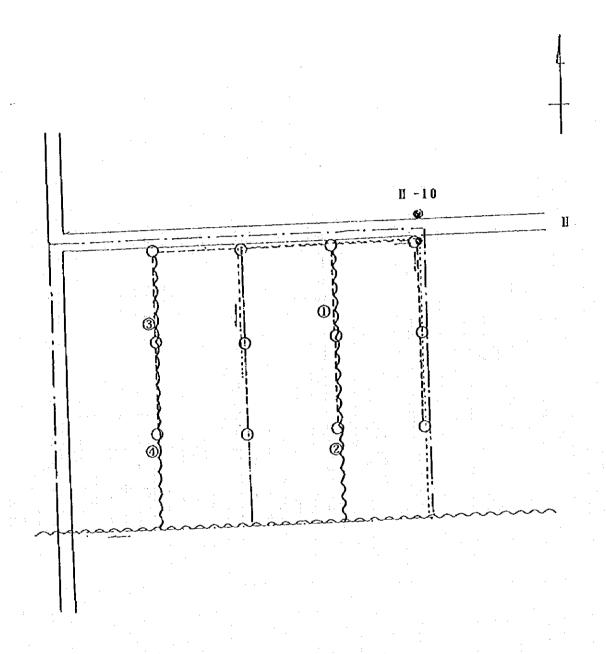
Plan horizontal du projet des installations terminales (Tozeur)
